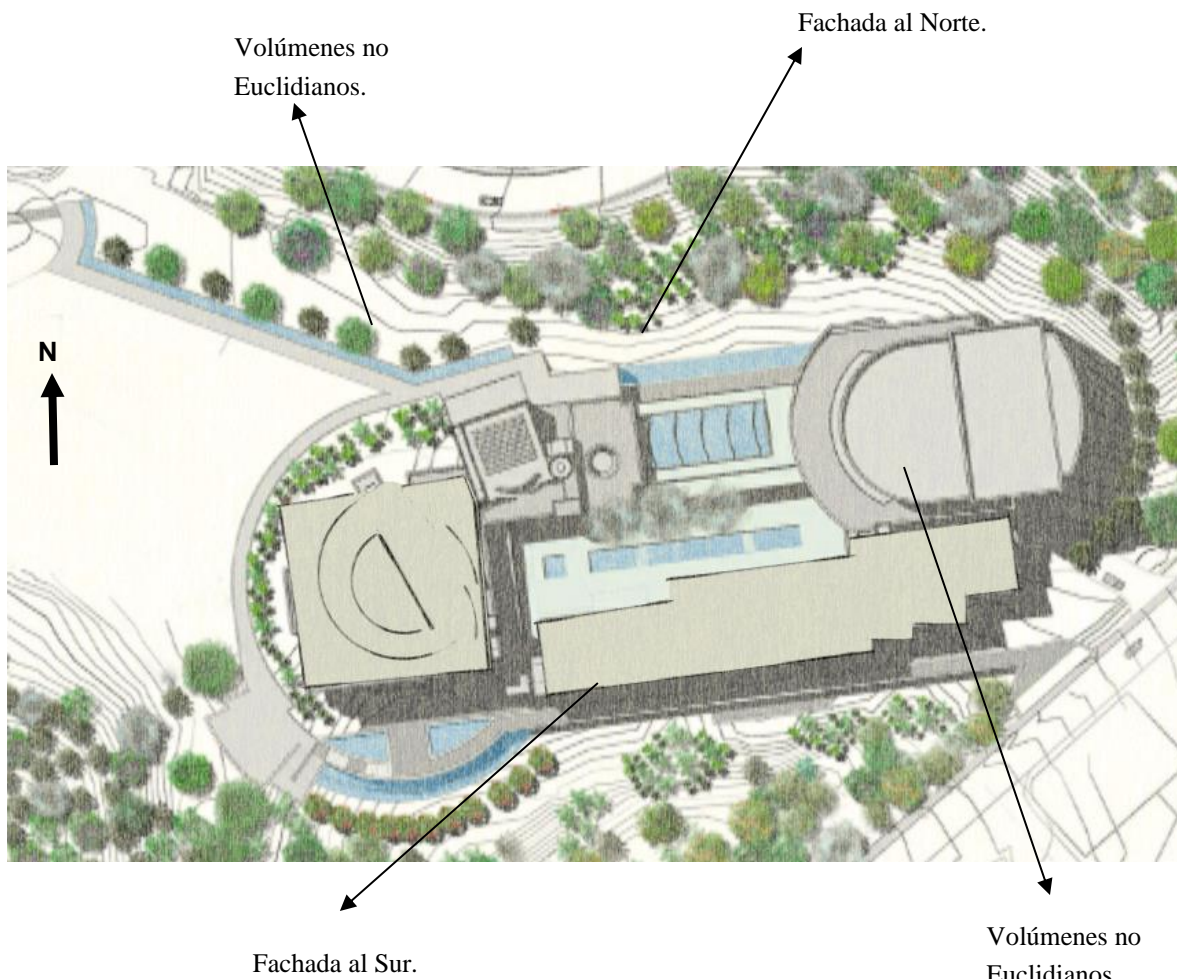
Figura XIII Orientación de fachada con mayor longitud hacia el Norte o Sur
